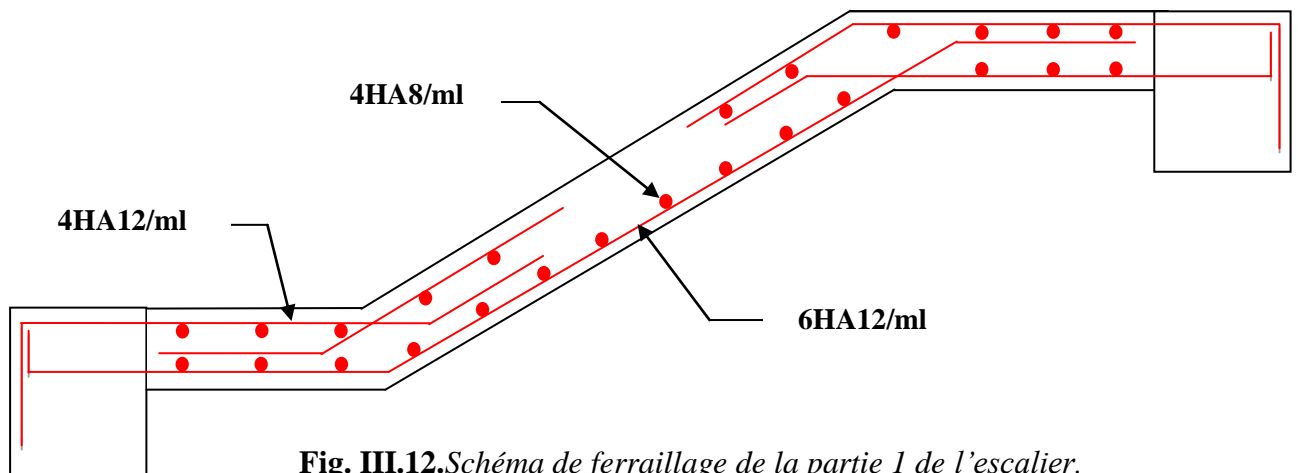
Schéma de ferrailage de la partie 1 de l'escalier.
